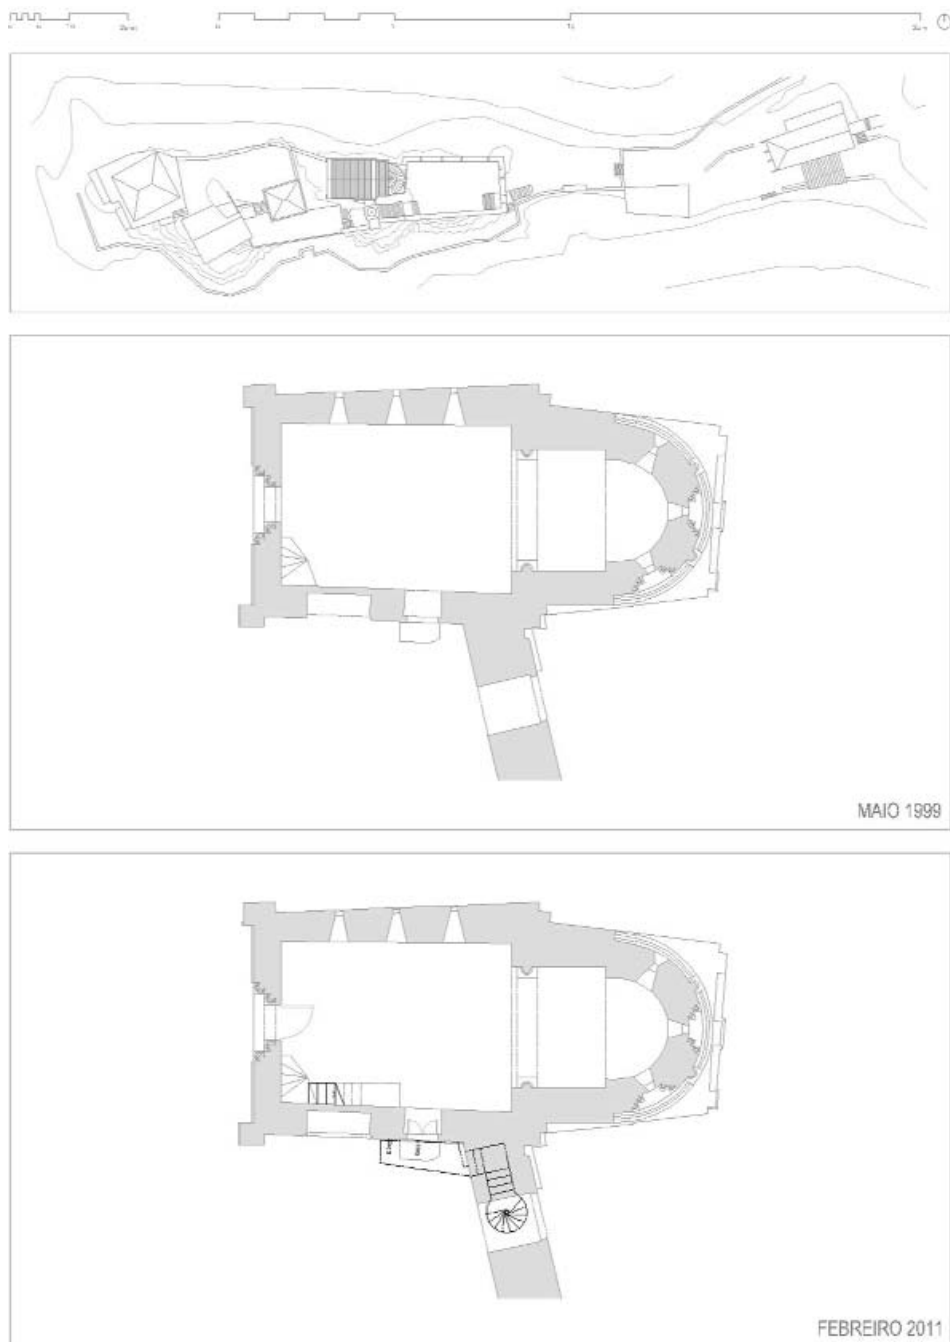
CAAVEIRO. Planta da Igreja de Santa Isabel.
